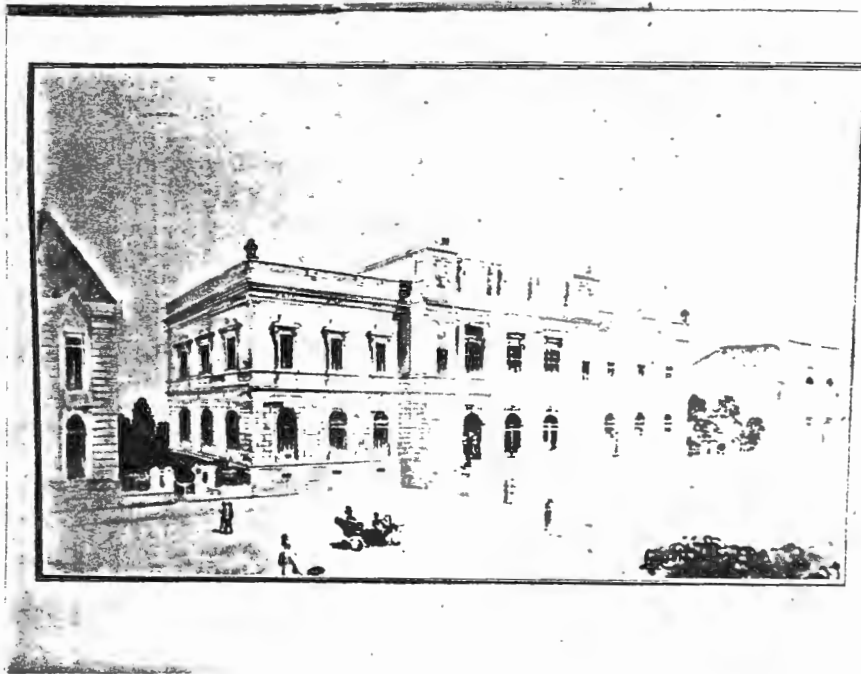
Fachada do Palácio da Justiça, projeto de E. D. Tessain.
